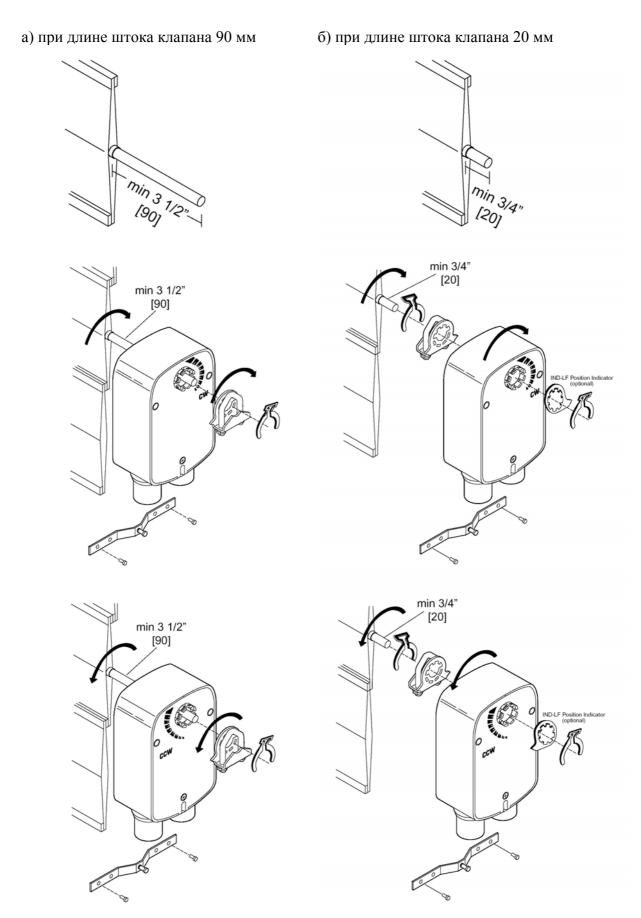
Установка и крепление исполнительного механизма на шток воздушного клапана
